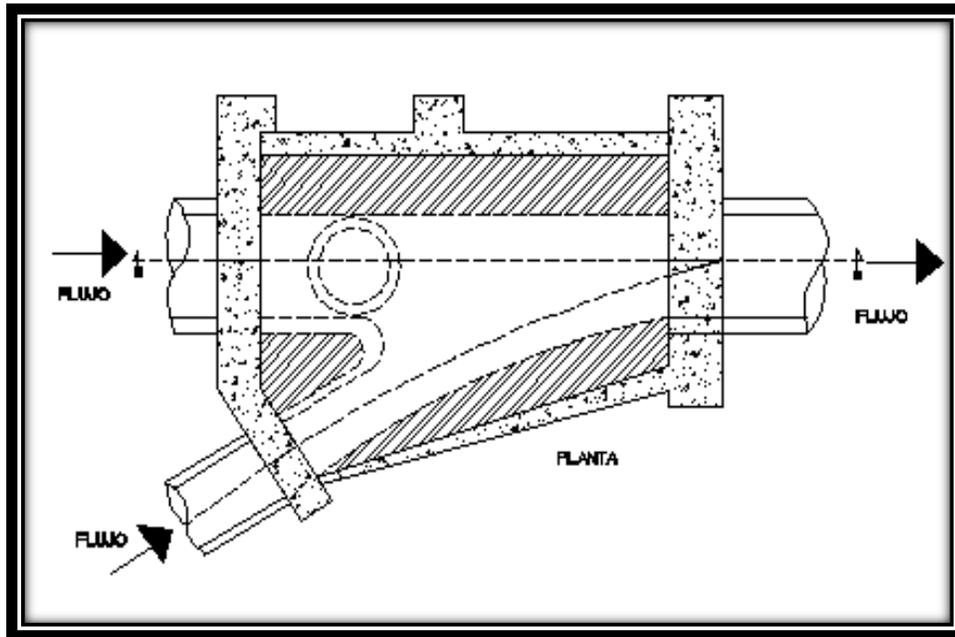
Diseño en planta para estructuras de pozos y caja de unión, (Ref. 1)
